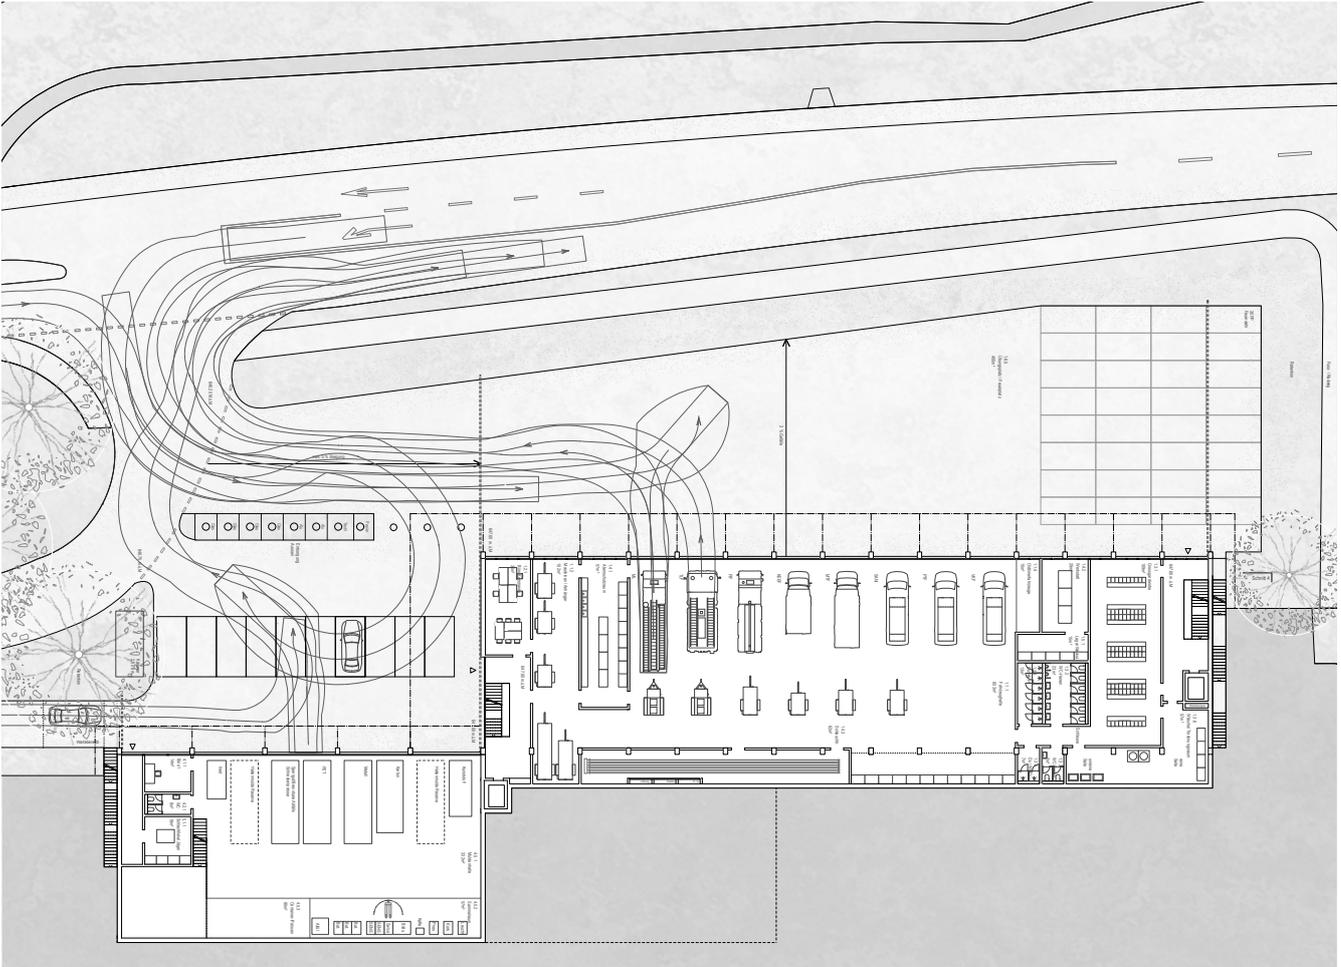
Grundriss untere Ebene Siegerprojekt
